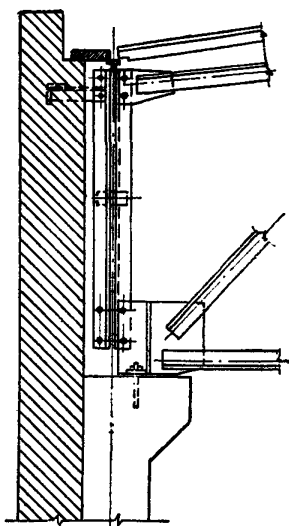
Шарнирное соединение фермы с колонной в здании со смешанным каркасом
